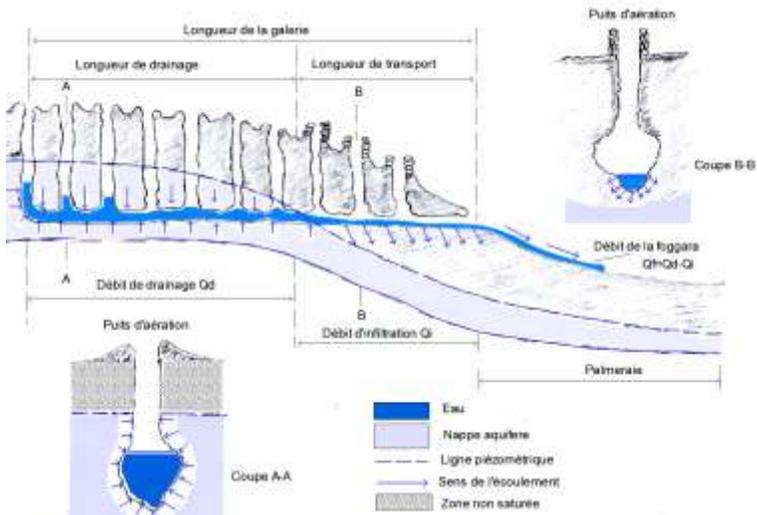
Schéma d'une coupe longitudinale de la galerie (partie amont de la foggara) (Remini, 2017)
